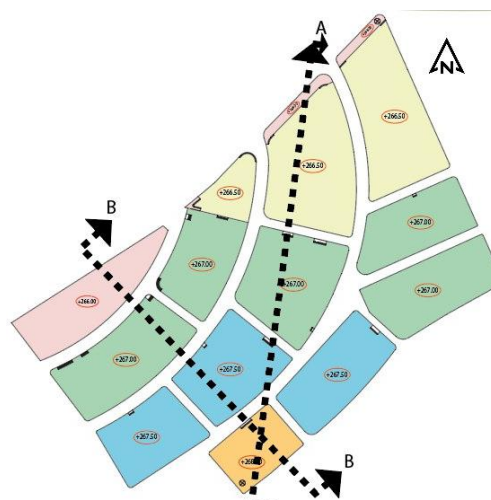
Plan de terrassement de site d'intervention (Auteurs).
